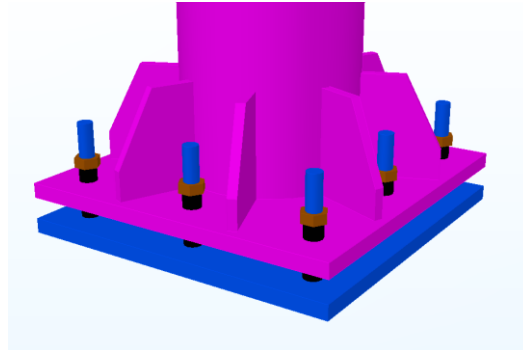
Vista 3D de la placa base de los pilares de la torre principal. Fuente: Memoria de cálculo de la Torre Multiaventura
